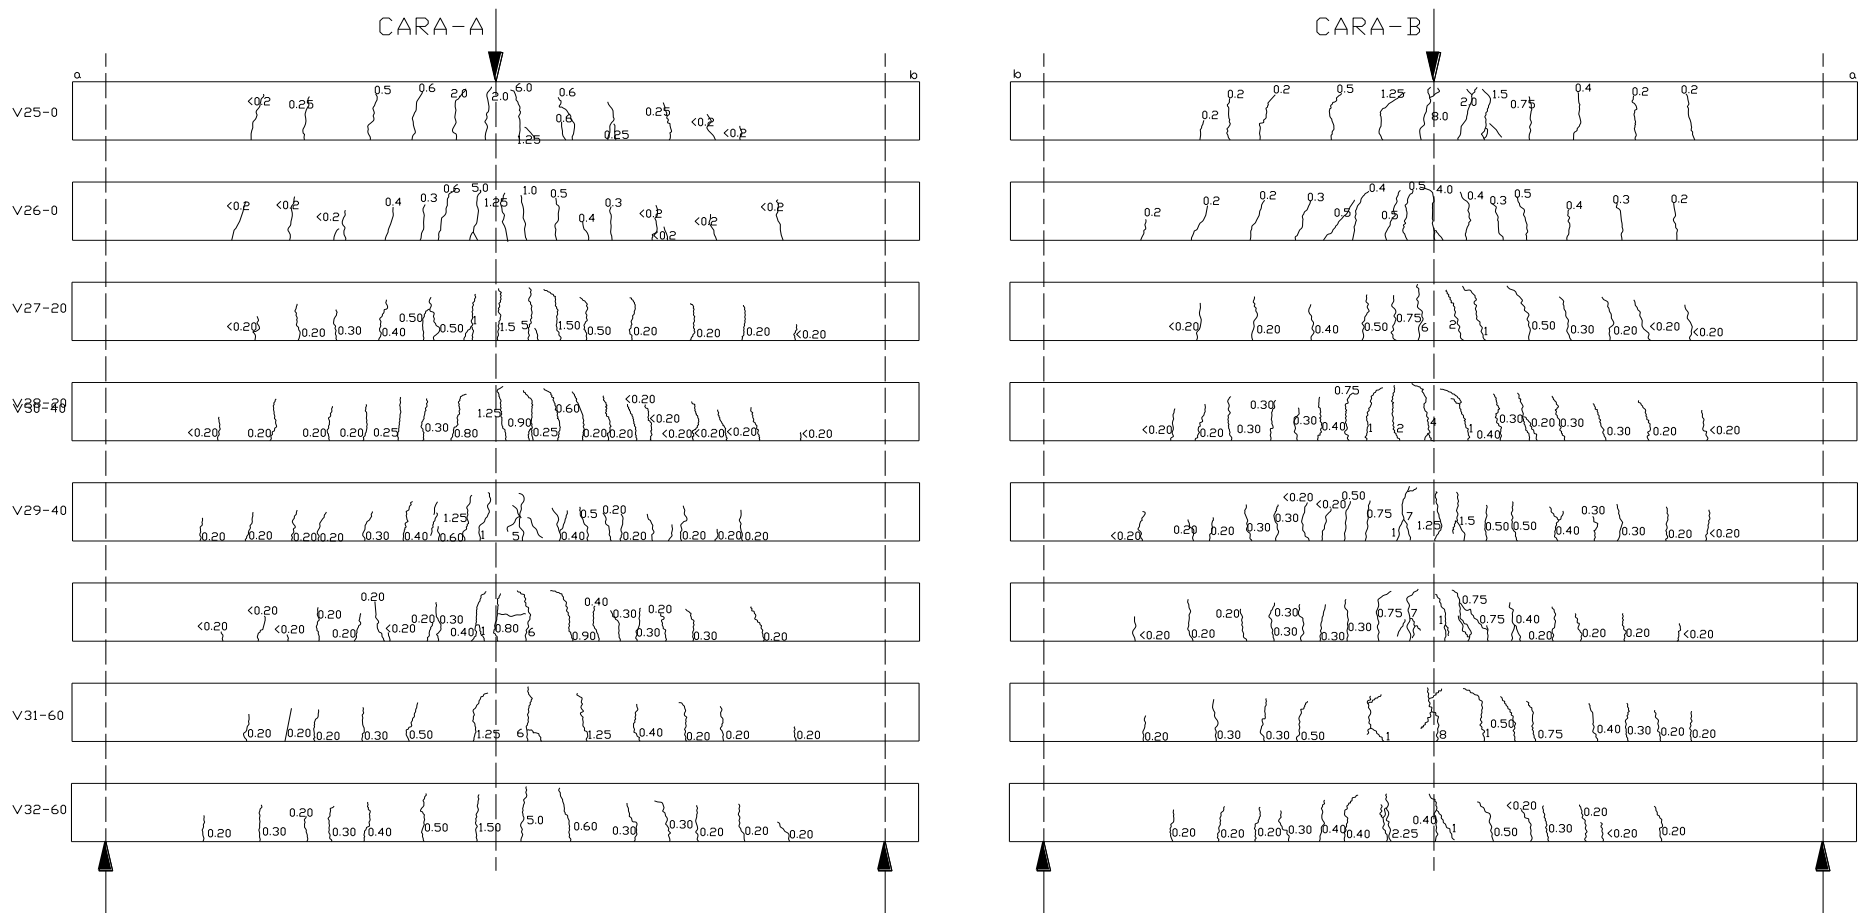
Patrón de agrietamiento en ambas caras de las vigas, $a/cm = 0.60$, edad de 24 semanas. Los valores sobre las grietas representan el ancho de grieta, en mm.
